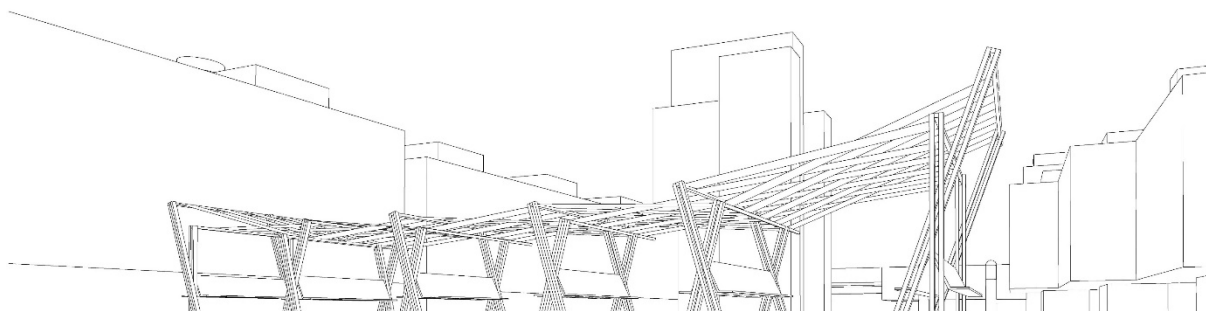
| Torrevecchia. Il progetto “Ombra TVB” con le torri sullo sfondo.
